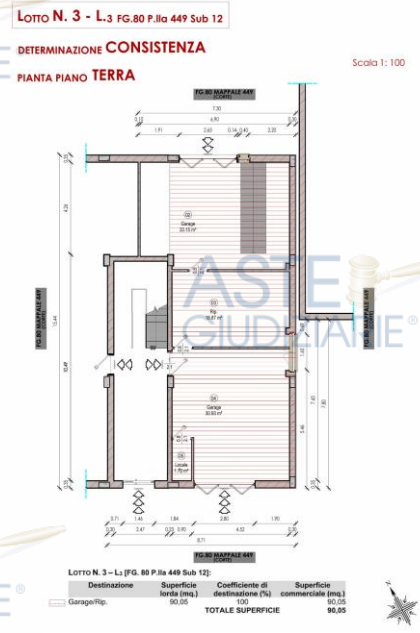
Determinazione consistenza Lotto L₃ (ALL. 11).
